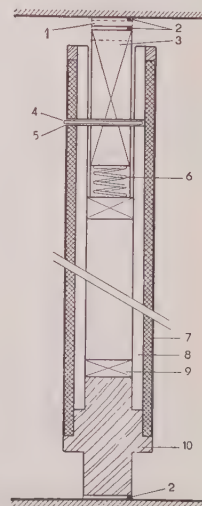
Vertikalschnitt durch Wandelement 1:7,5
